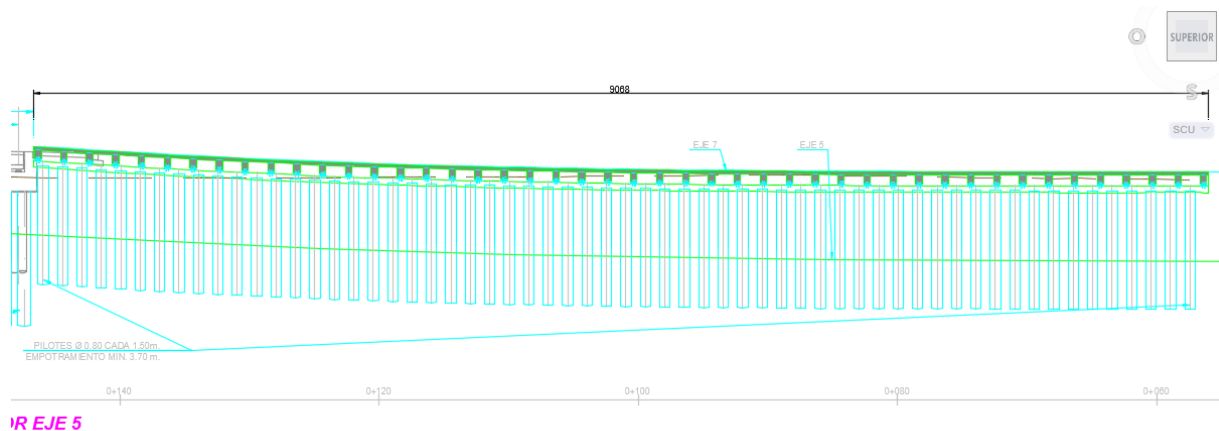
Alzado de estructura. Fuente: IDOM-DEHC.
